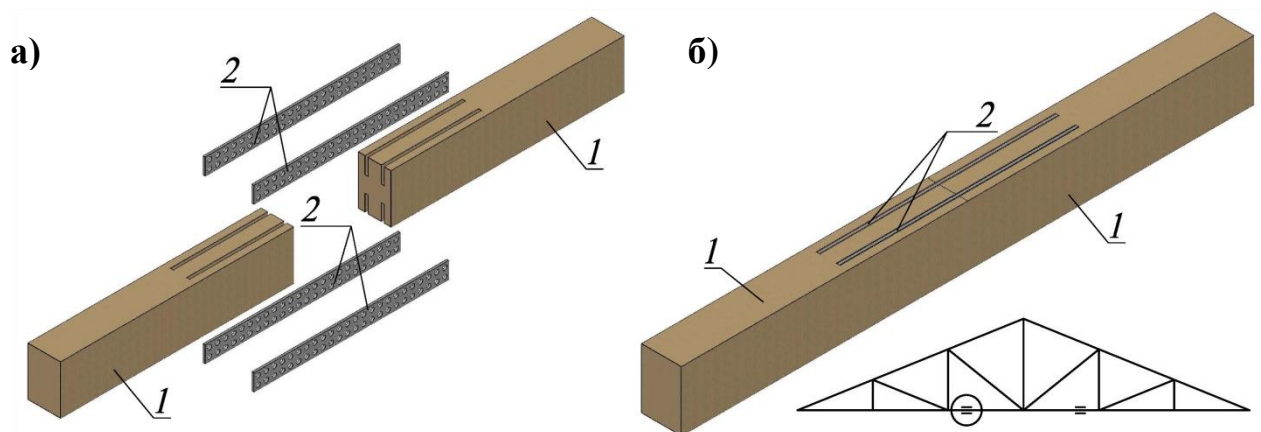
Стык нижнего пояса фермы на плоских стальных стержнях в разобранном (а) и собранном (б) виде: 1 - элемент нижнего пояса; 2 – плоский стержень
